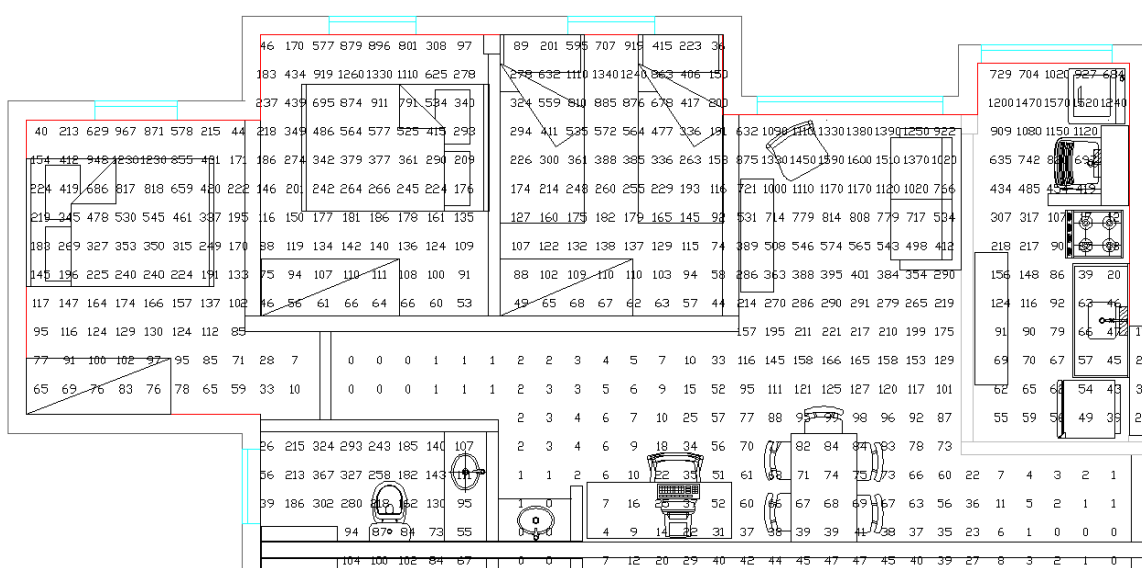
Distribuição da iluminância ponto a ponto no pavimento tipo (em lux).
